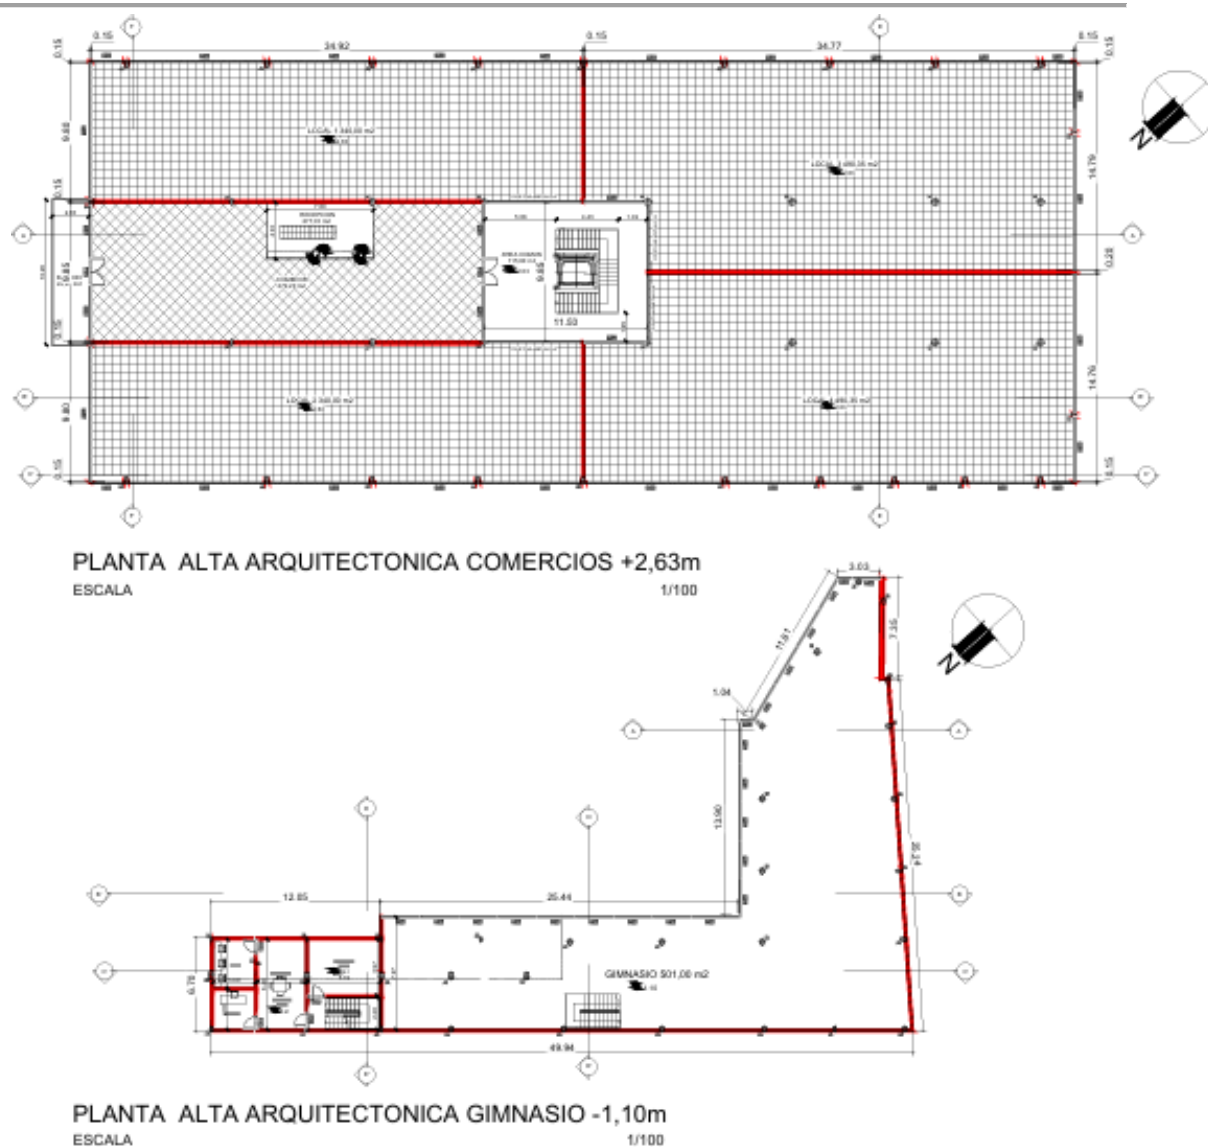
Planta alta arquitectónica del Paseo Comercial.
